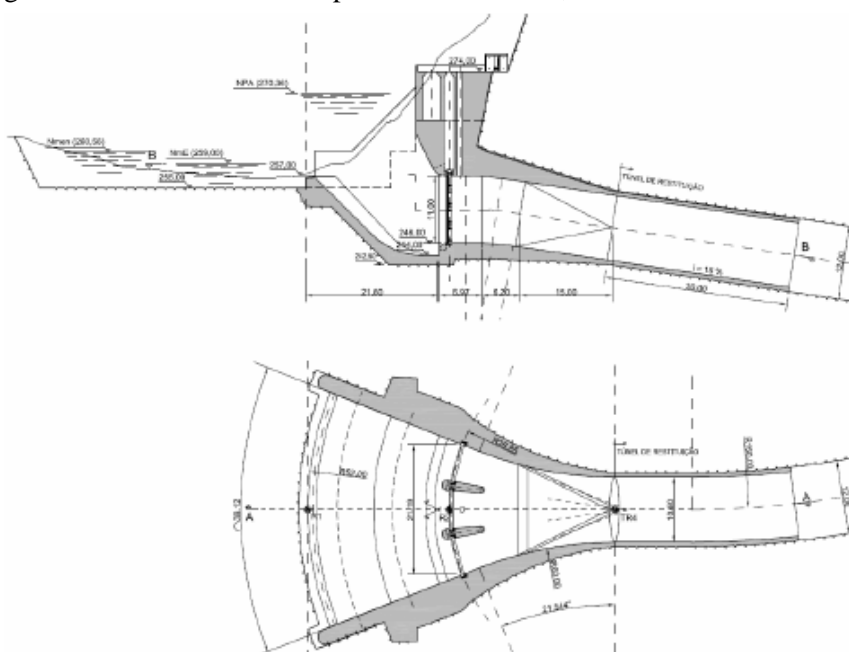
Restituição - Planta e perfil longitudinal [18].
